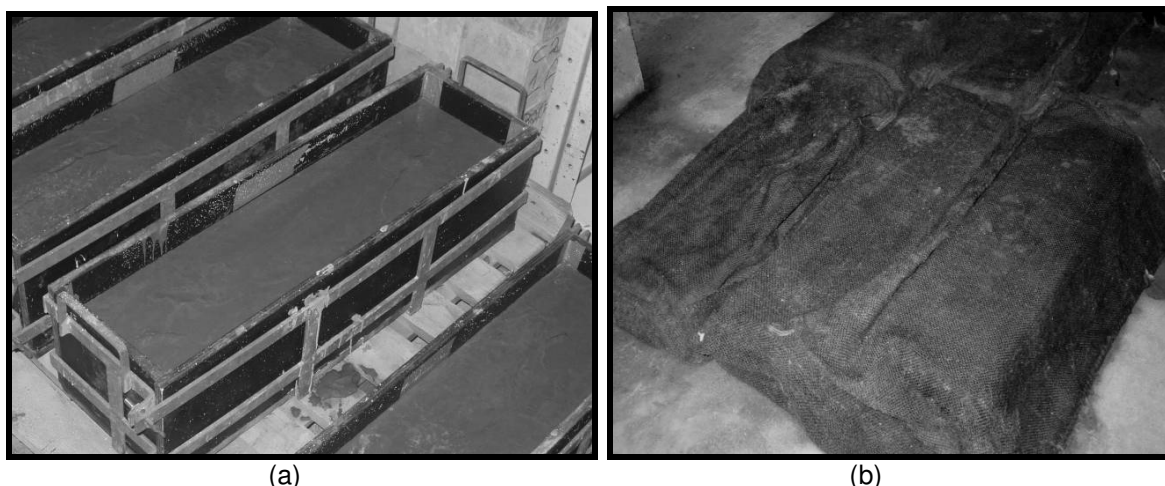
Protótipos: (a) moldagem (b) cura úmida de 7 dias.
